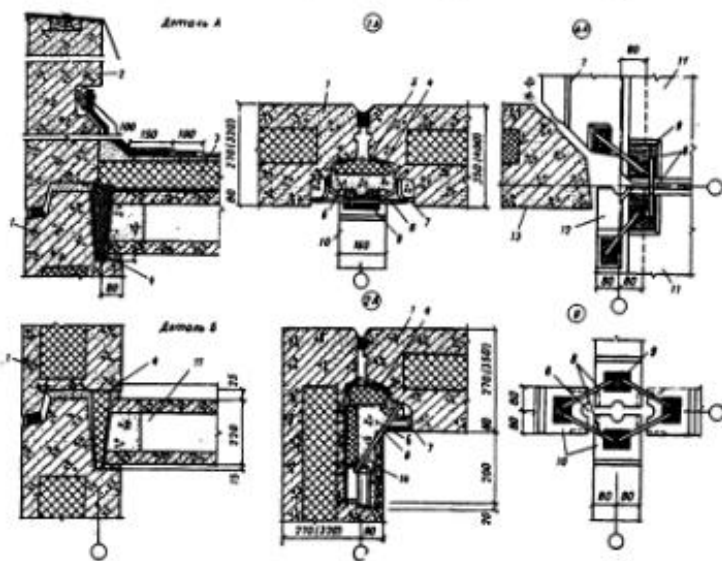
Детали и узлы панелей наружных (трехслойных) и внутренних стен: деталь А — устройство парапета; деталь Б — горизонтальный стык наружных стен; 1 — панель наружной стены; 2 — панель парапета; 3 — совмещенная крыша построенного изготовления; 4 — утепляющий вкладыш; 5 — обкладка воздухонепроницаемым рулонным материалом; 6 — бетон замоноличивания; 7 — петлевой арматурный выпуск; 8 — соединительный элемент; 9 — закладная деталь; 10 — панель внутренней стены; 11 — панель перекрытия; 12 — панель внутренней стены лестничной клетки; 13 — то же, наружной; 14 — штукатурка по сетке.
